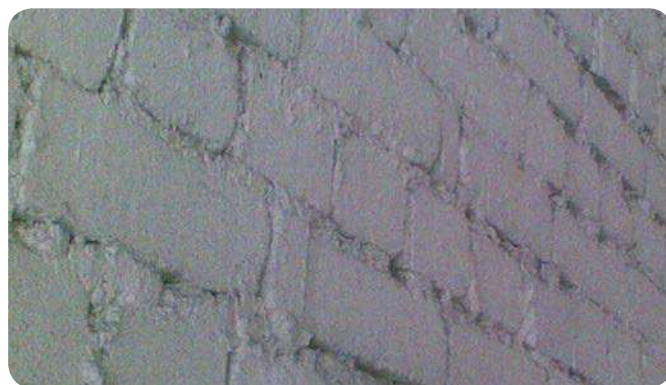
El polvo queda atrapado en la mampostería abierta.
